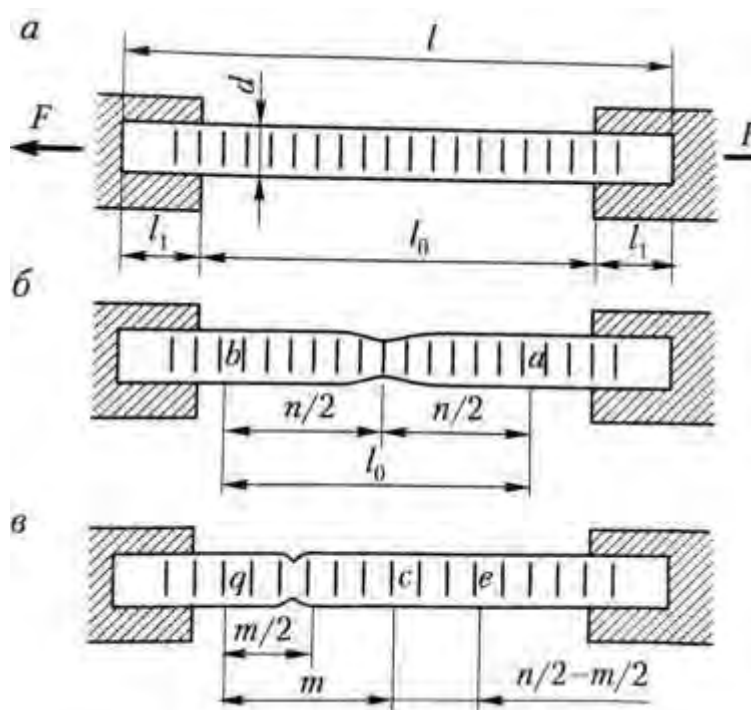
Образцы из арматурной стали: а) до испытаний, б)в) после испытаний на растяжение
